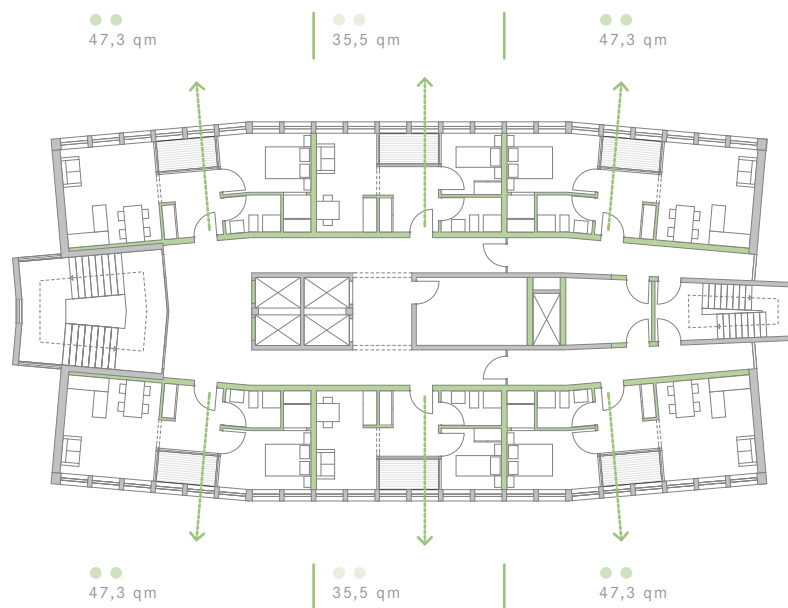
Grundriss Umbau - Grundrissaufteilung
